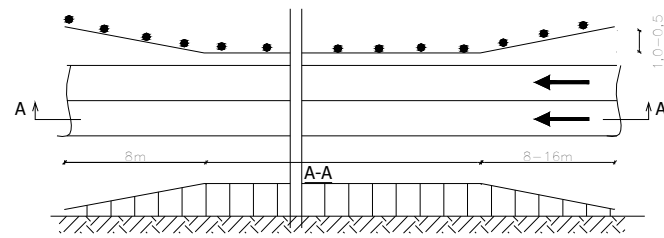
Lokalizacja betonowych barier ochronnych na drogach dwukierunkowych jednojezdniowych.
